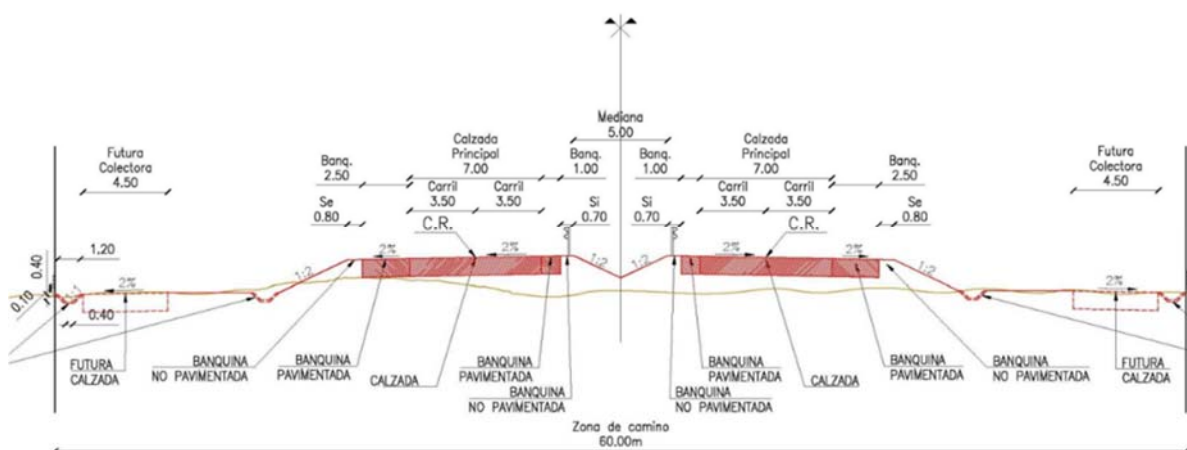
Perfil Tipo de Calzada Principal en zona rural en variante
